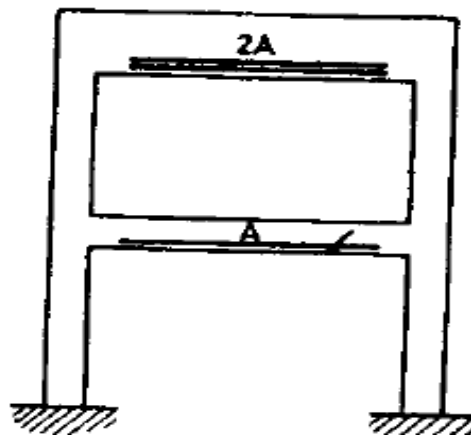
Fisuras debidas a retracción en vigas.
